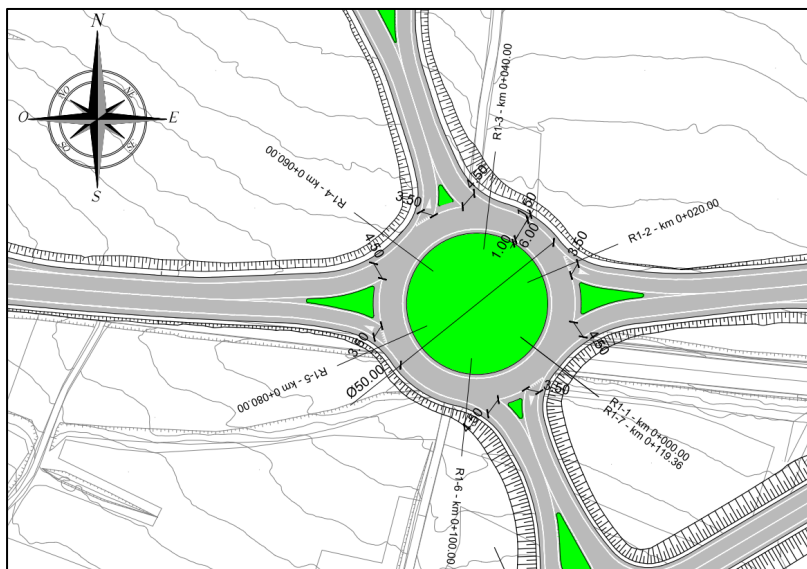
Estratto della planimetria di progetto della rotatoria 1
